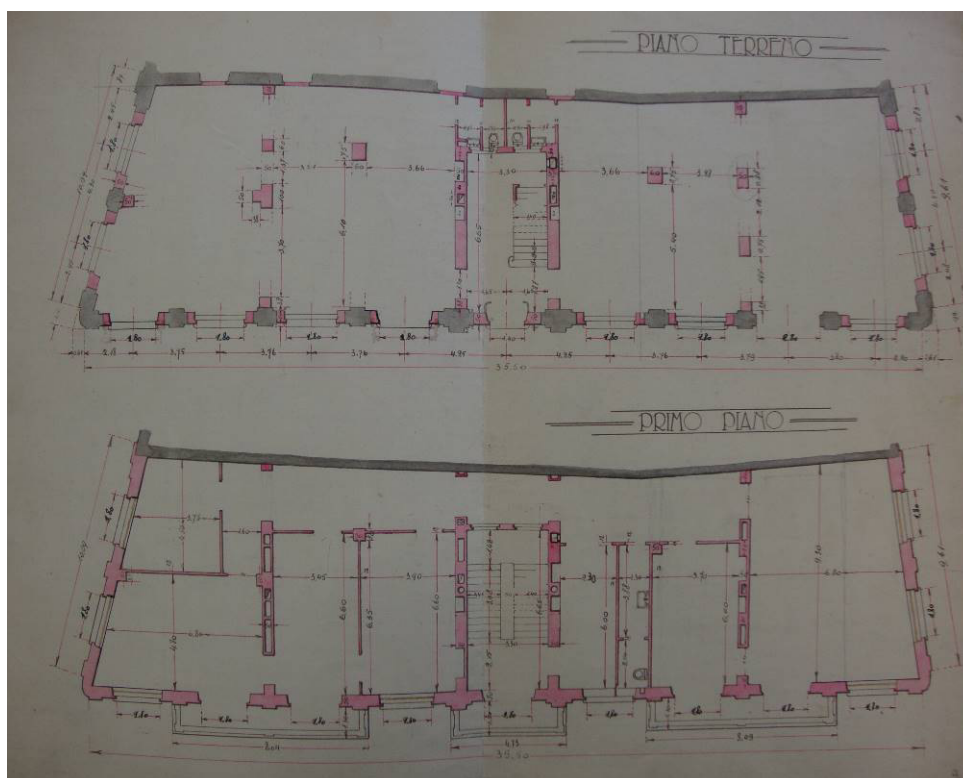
Pianta Piano Terreno; pianta primo piano, - ASCC, Città di Cuornè - Progetto della Casa del Fascio – scala 1:100, non inventariato, senza data, Ing. Corrado Gay.
